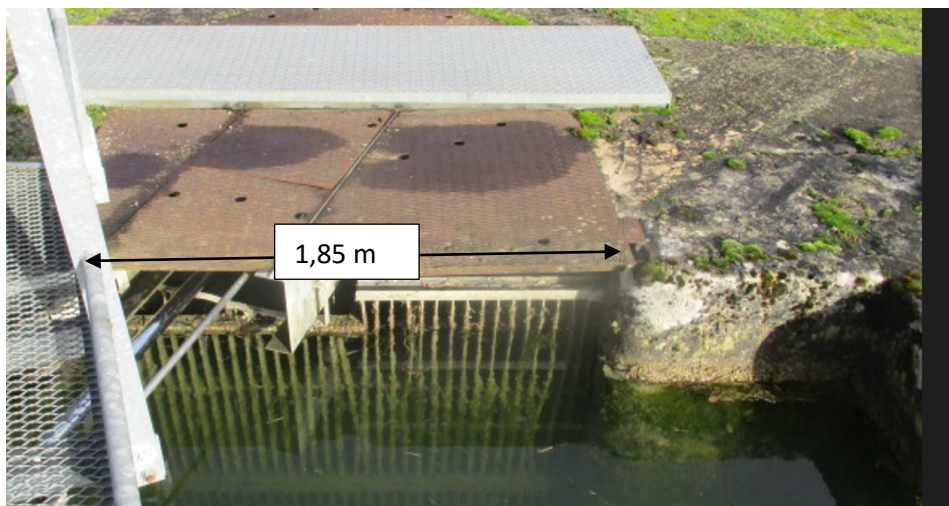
Grille d'aqueduc amont à remplacer (Ecluse 29 du Moulin de Tours)
